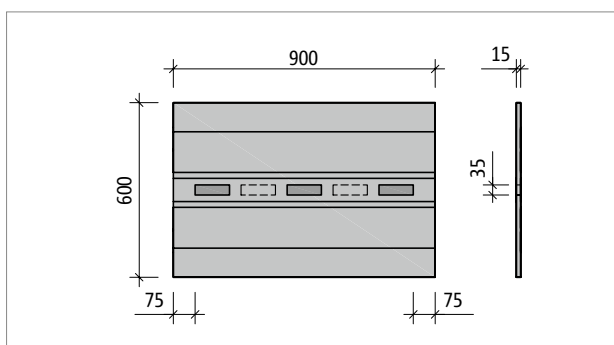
Tronsole® B-V1...-B600: Produktgrundriss
